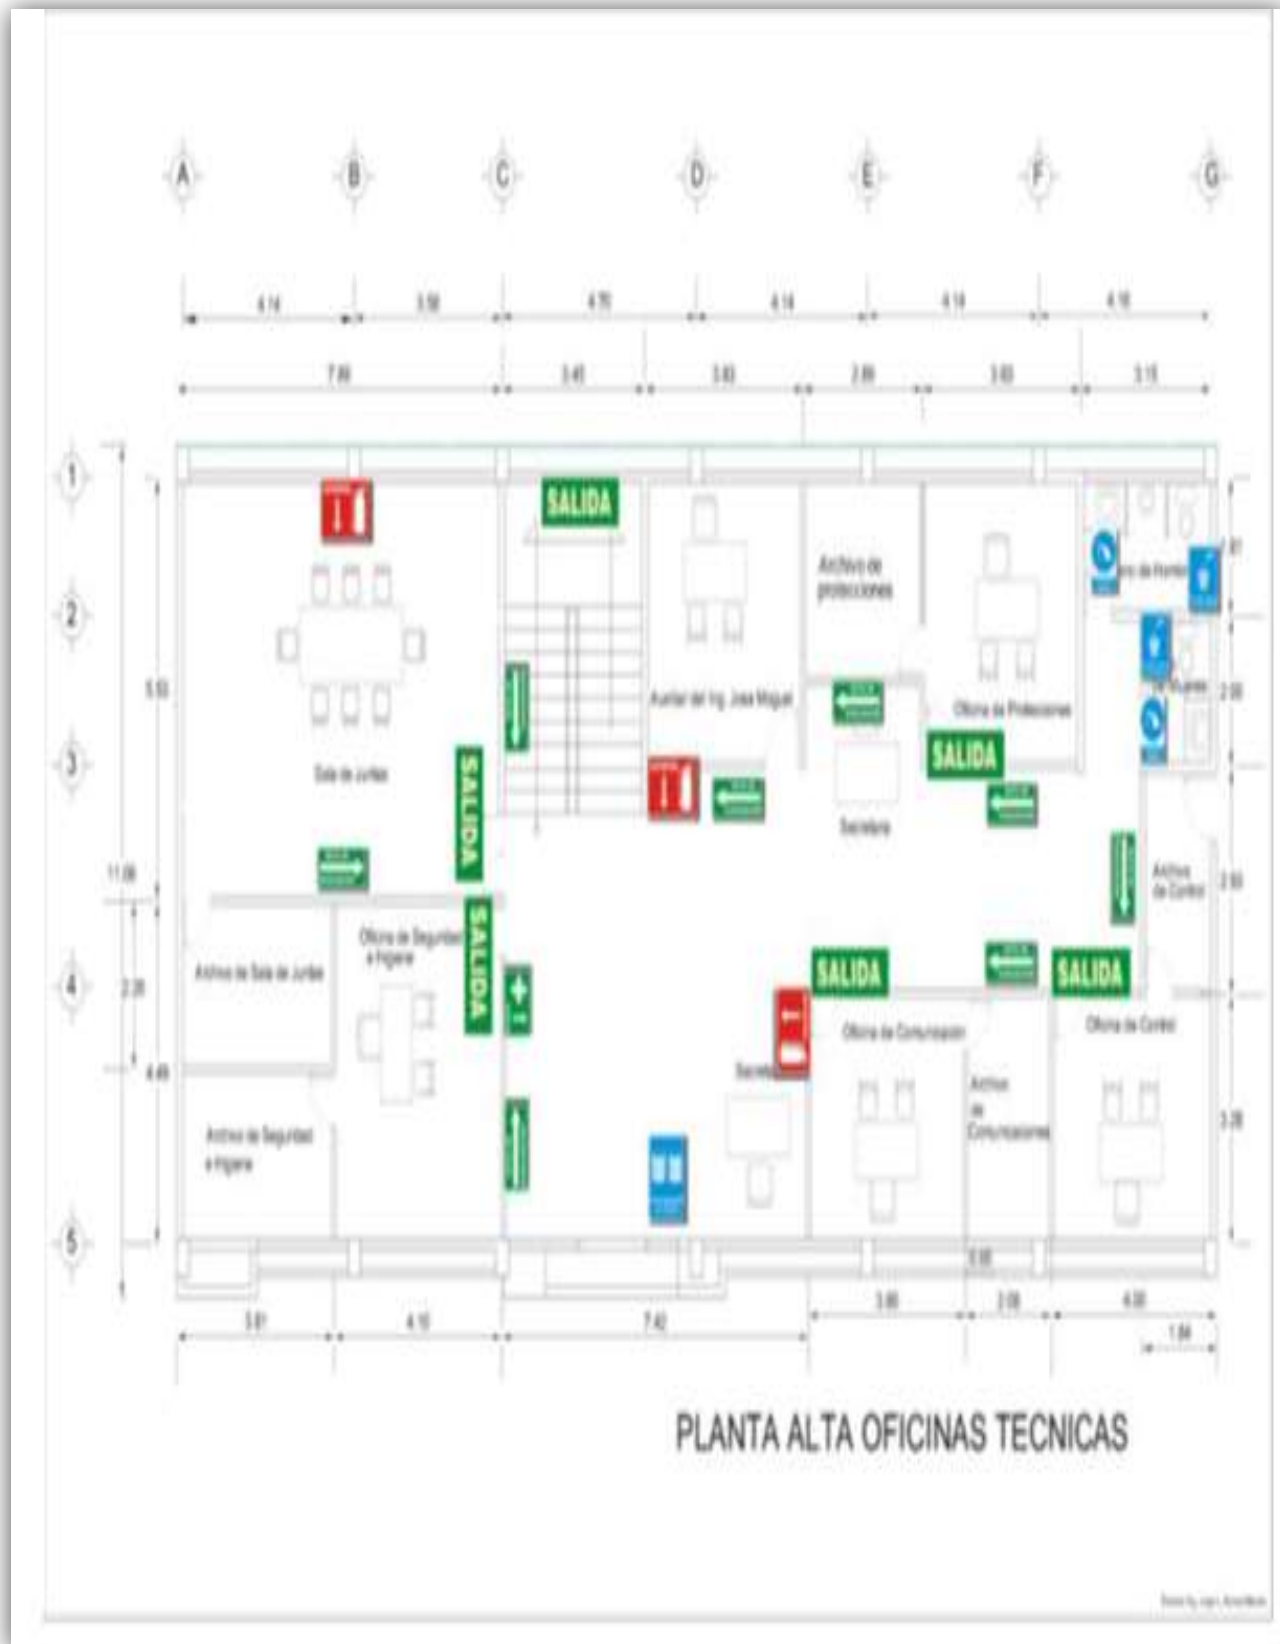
Plano de la planta alta de las Oficinas Técnicas de Angostura
